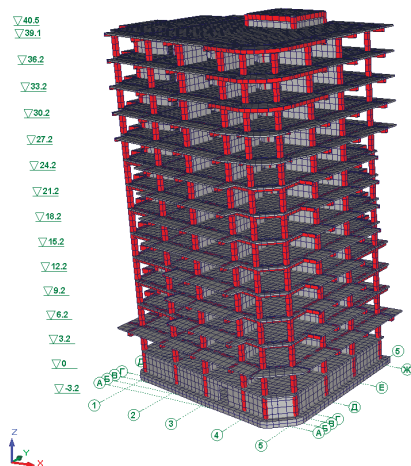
Расчетная схема монолитного железобетонного каркаса
